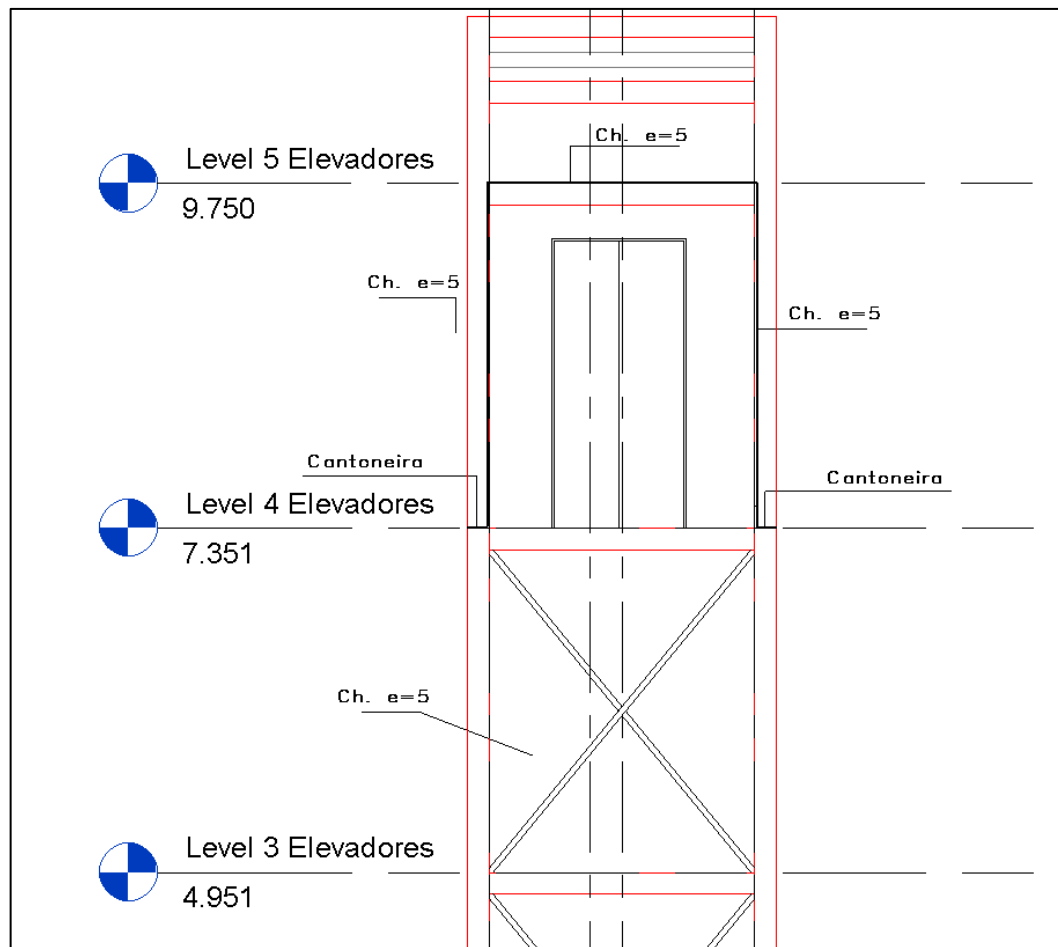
Alçado exemplo da caixa de Elevadores
